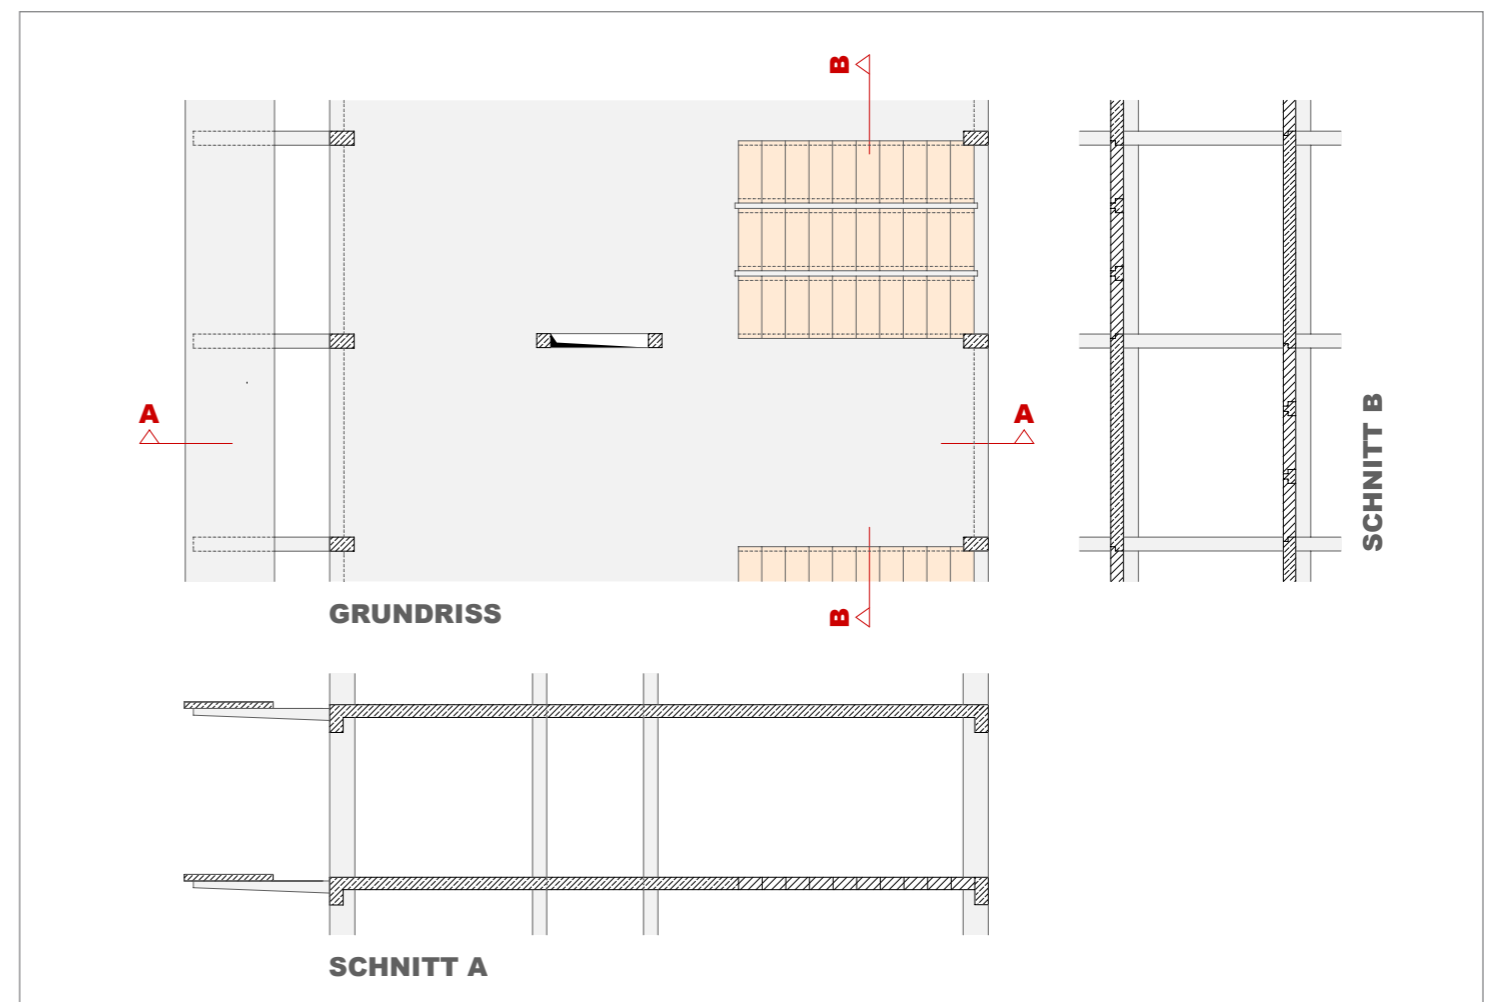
Grundriß und Schnitt des Konstruktionssystems
